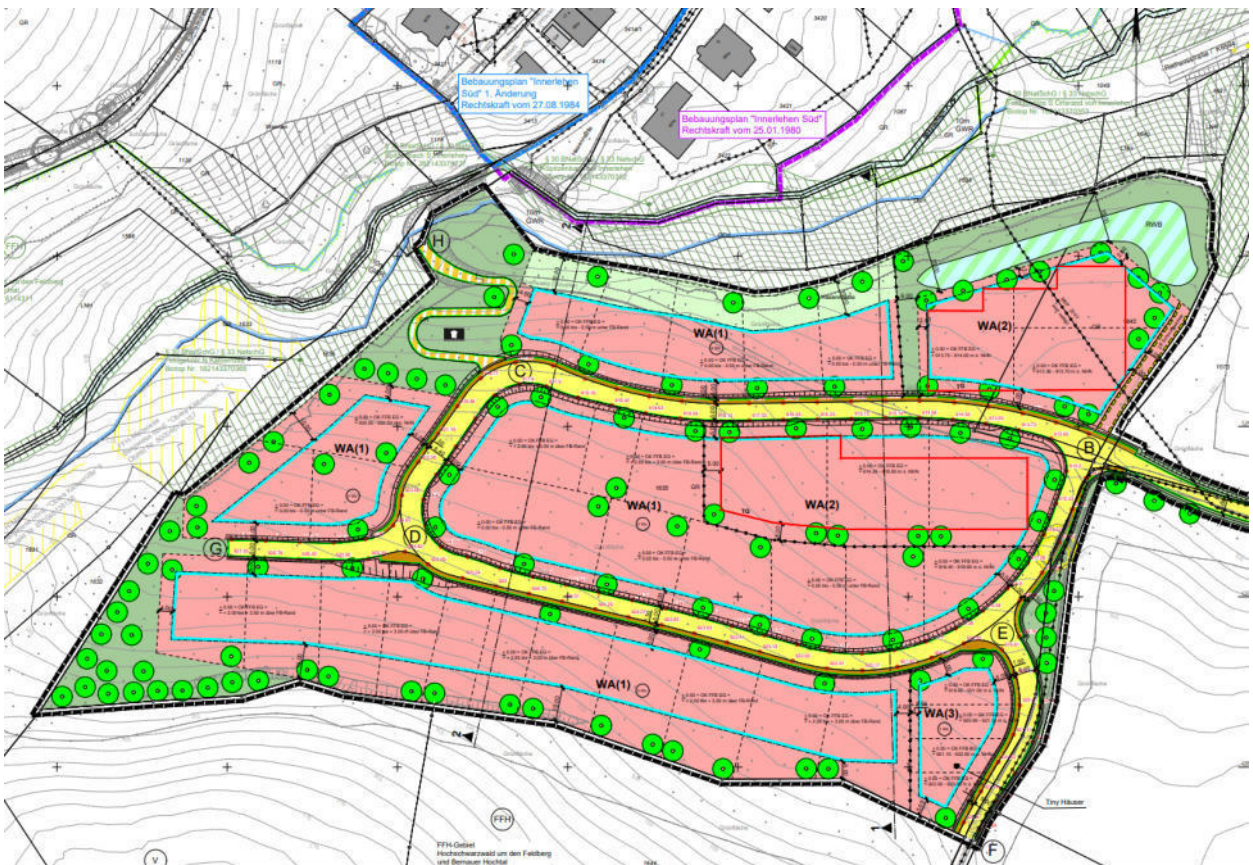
Plangebiet „Auf dem Buck“ (Planstand vom 14.05.2024), westlicher Teil
